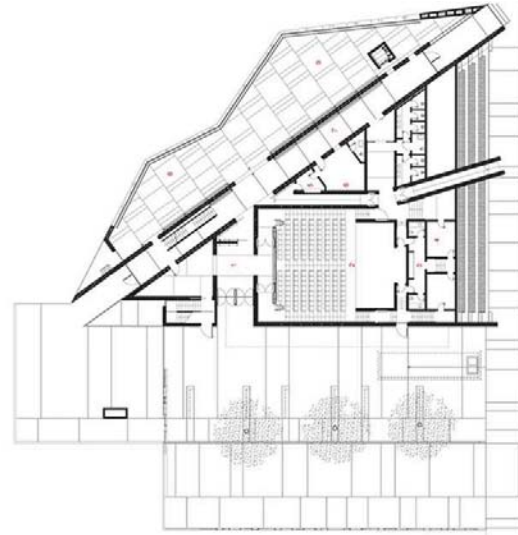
Archea Associati (2019), [Plano de planta baja, Biblioteca Curno] Recuperado de <https://www.archdaily.mx>
